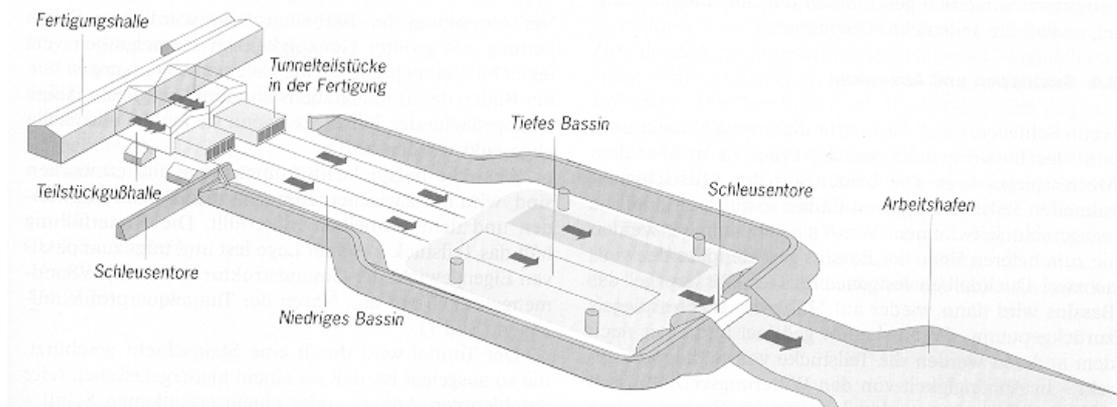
Tunnelfertigungsverfahren "Trockendock"
